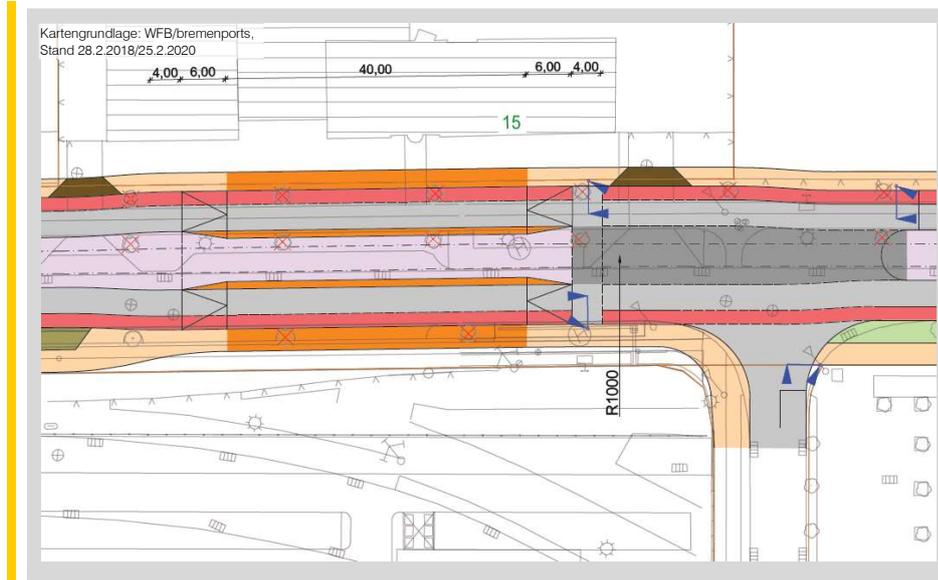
Ausschnitt Lageplan Haltestelle vor Schuppen 1
